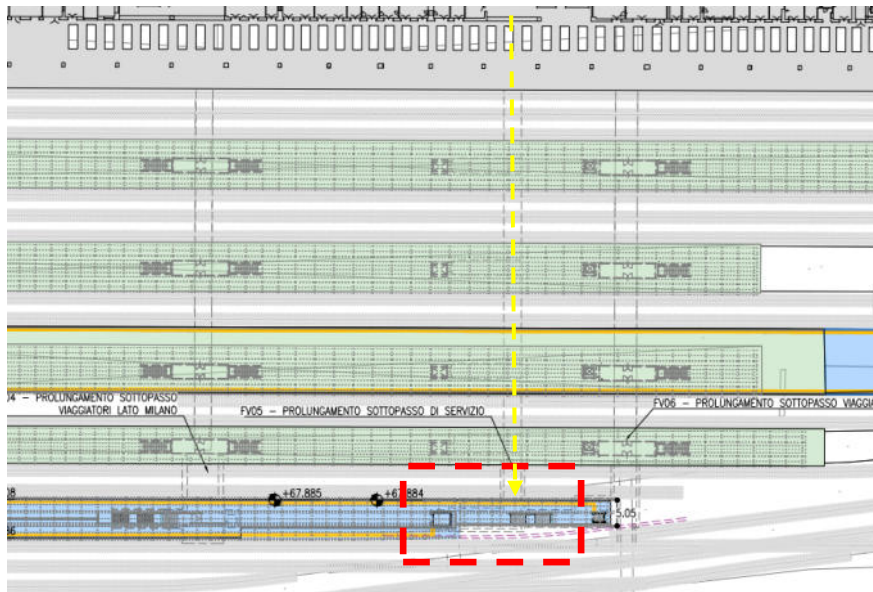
FV05 - Prolungamento sottopasso di servizio – Planimetria di inserimento
